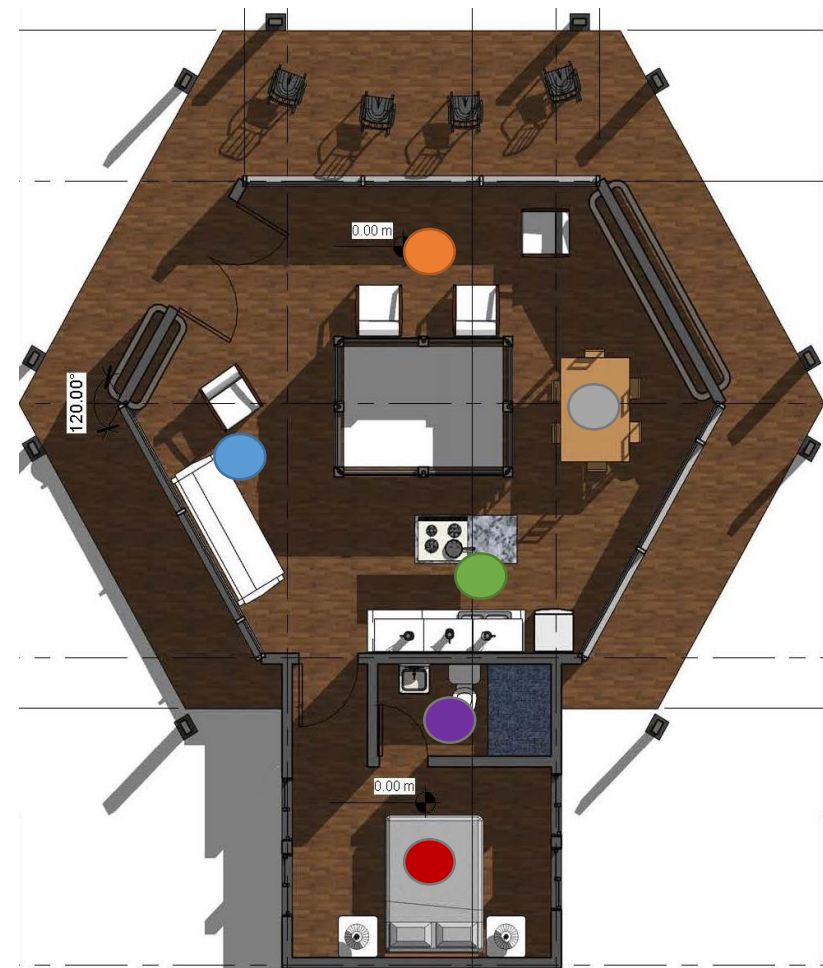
Planta arquitectónica de cabaña. Monte Carmelo
